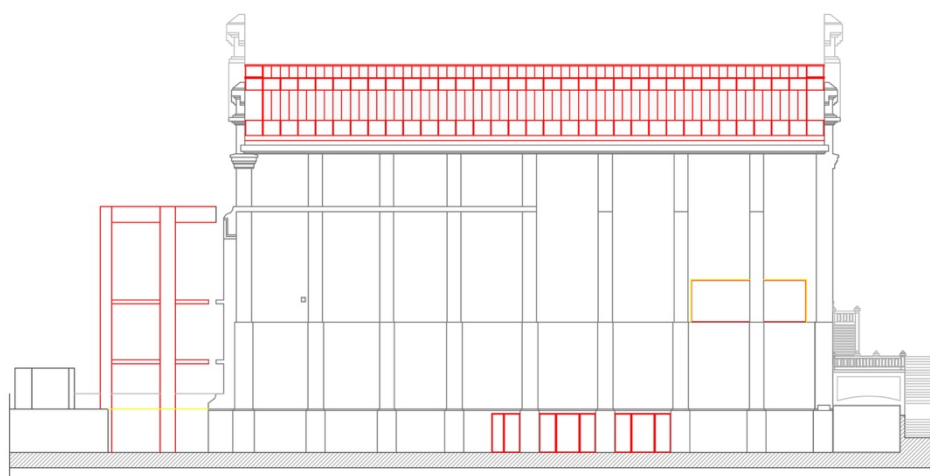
Sobreposição dos elementos a construir e a demolir, alçado sul;
